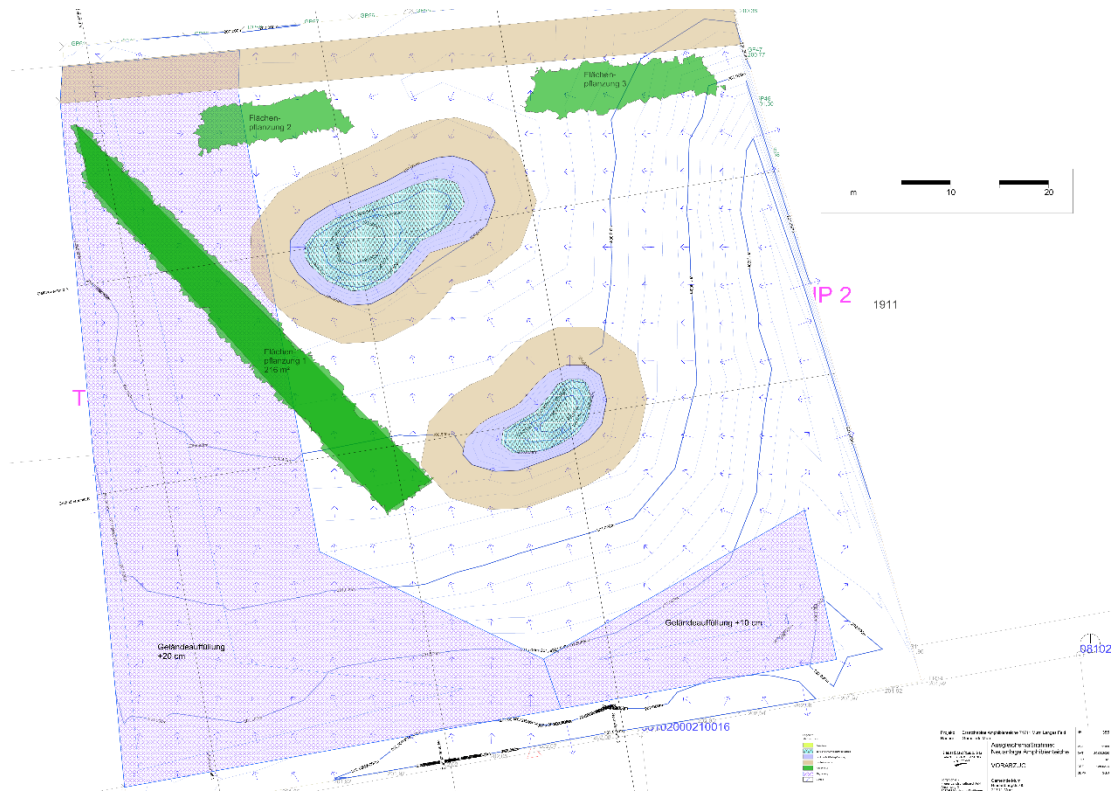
Plangrundlage der beiden Ersatzgewässer (aus: landschafts-Architektur & Planung Jörg Schießl, Ausgleichsmaßnahme Neuanlage Amphibienteiche (Vorabzug 30.04.2020)).
